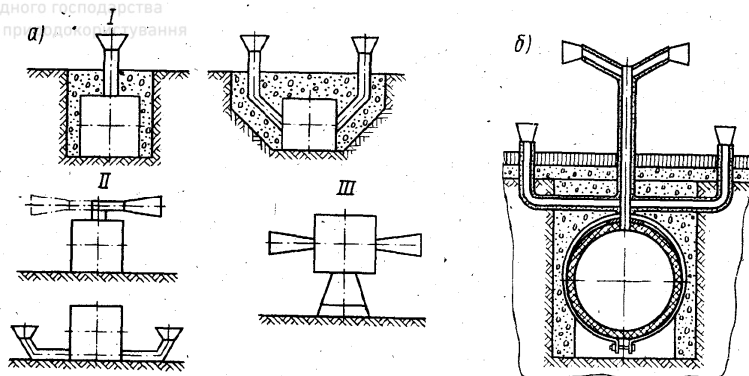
Типи повітропроводів: а — поперечні перерізи; I - підземний; II — наземний; IV - надземний; б — з бетонних труб
